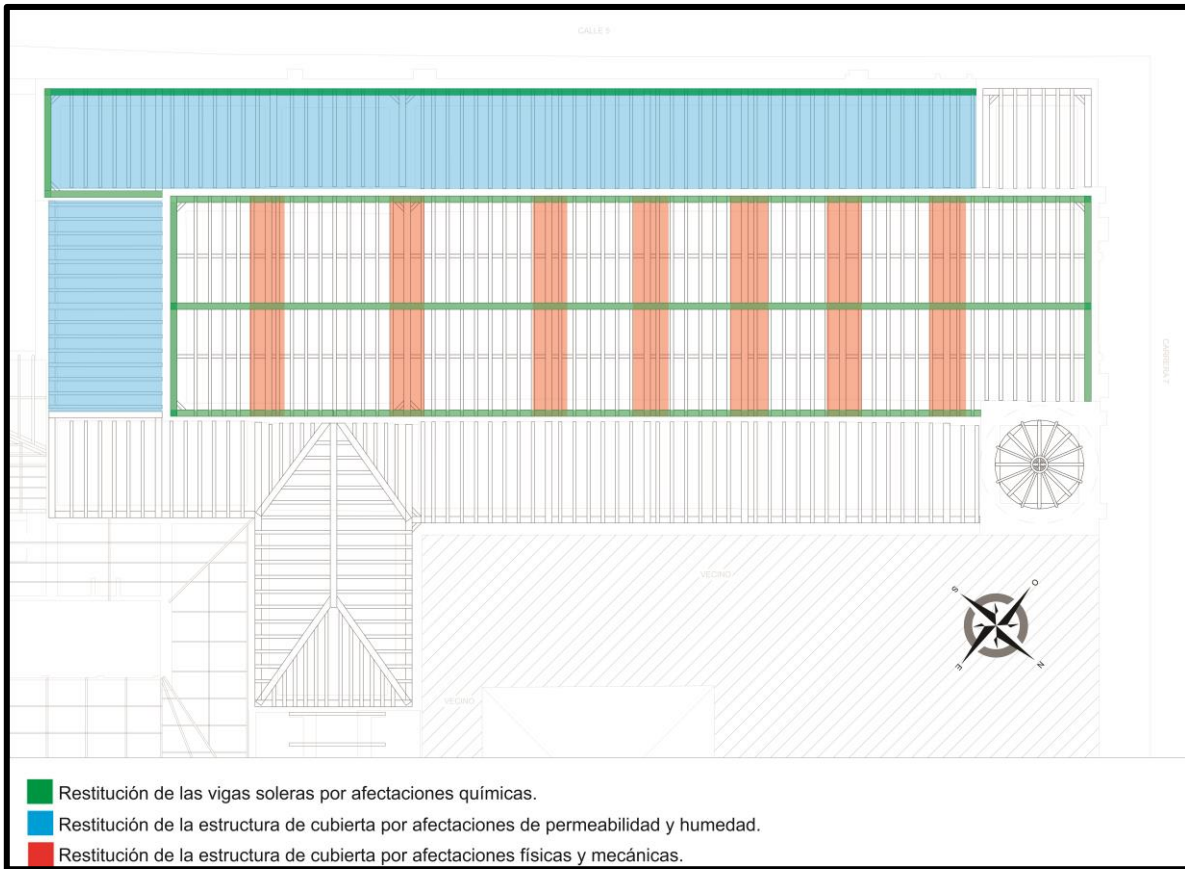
ubicación de las afectaciones que serán intervenidas en la restitución de la estructura de cubierta.
